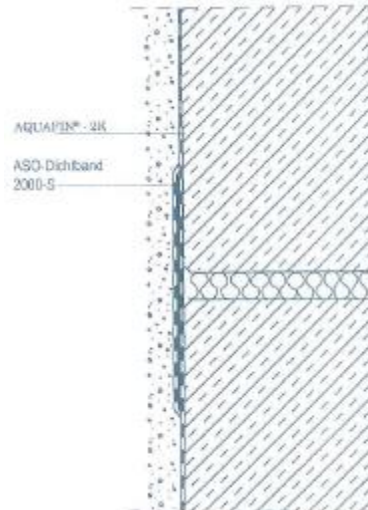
joints de murs de fondation exposés à une pression hydrostatique
